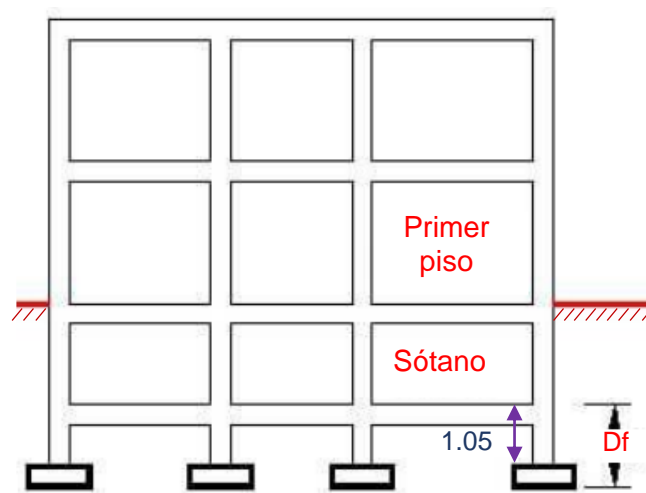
Profundidad de cimentación en zapatas bajo sótanos
